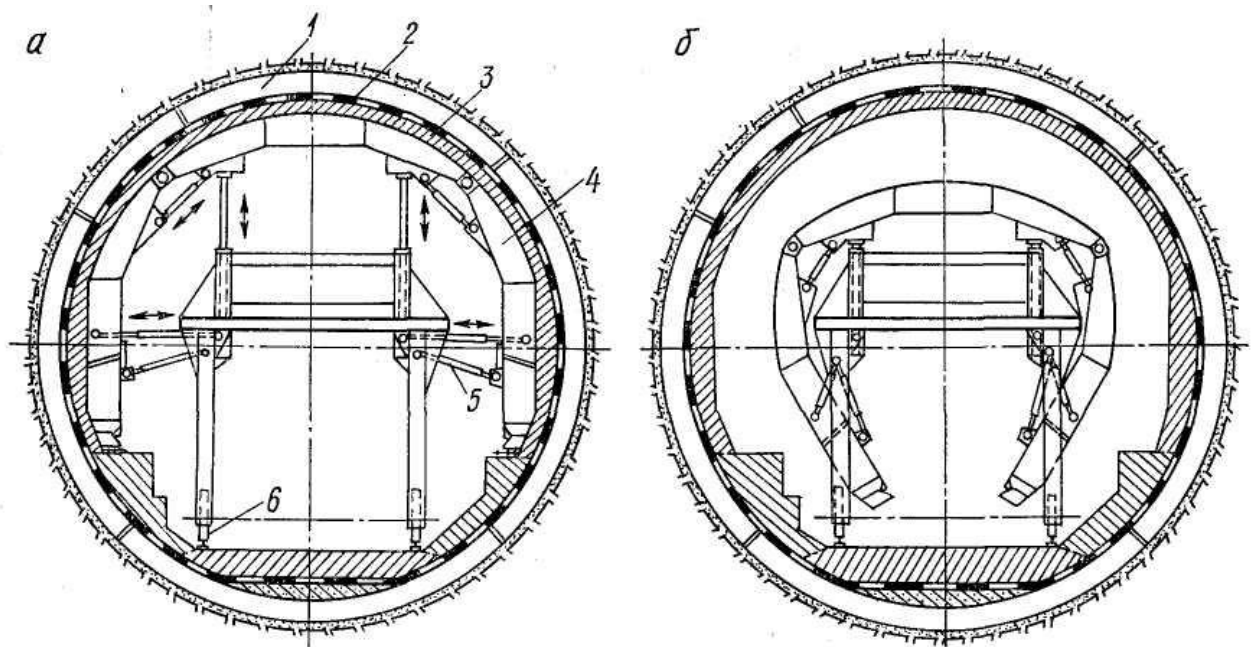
Котюча опалубка для бетонування тунелів:
